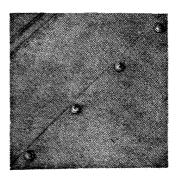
Внешний вид сварных точек на мембранном покрытии
